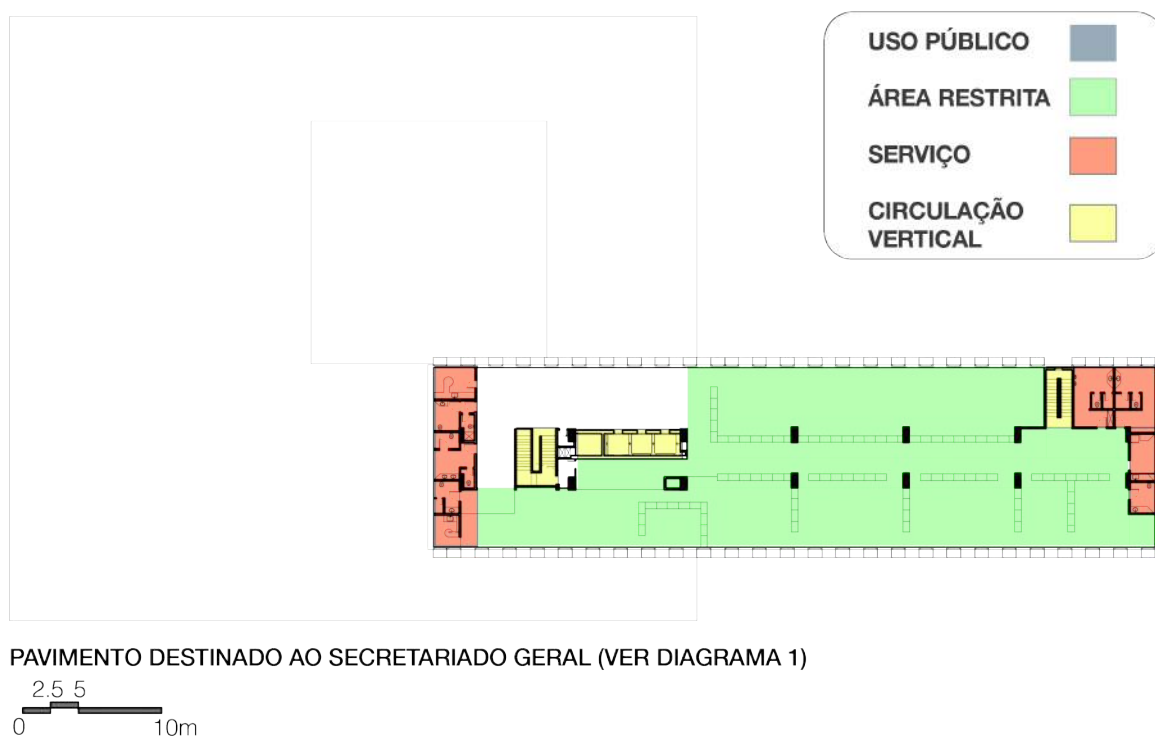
Planta de setorização do sexto pavimento do edifício da Reitoria da UMG.
